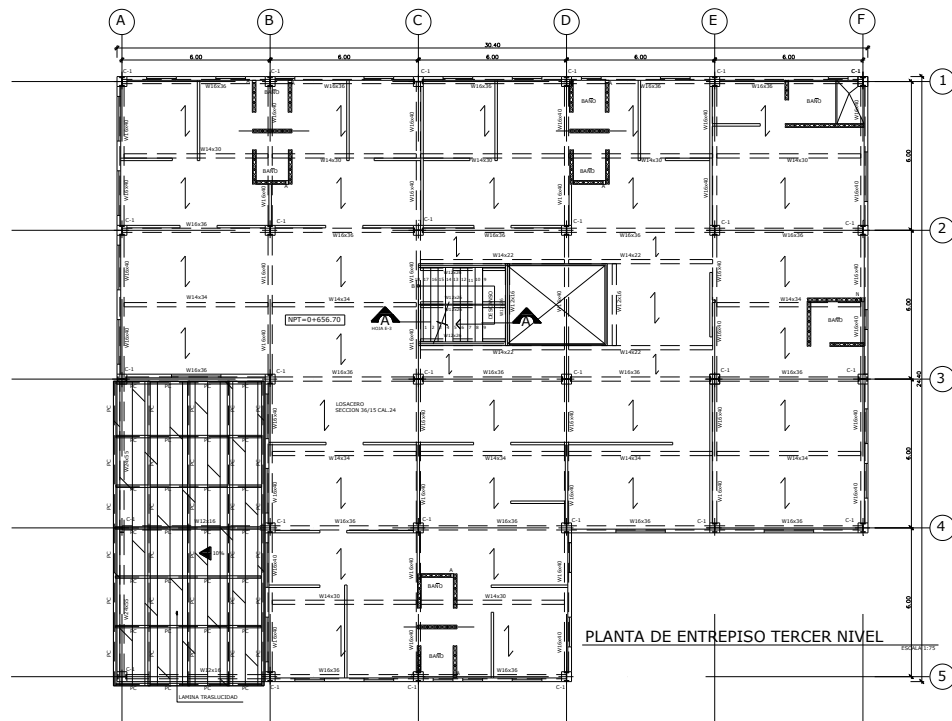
Planta estructural del primer, segundo y tercer nivel
